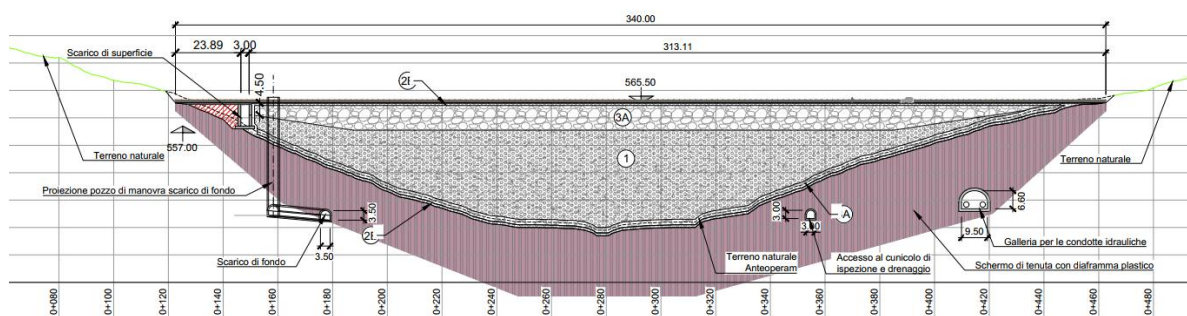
Alternativa 2 (A1*+D), diga D, profilo (estratto da [25])
